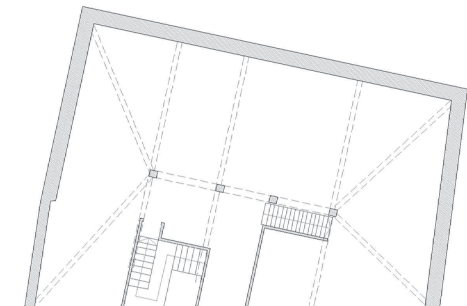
16. PLANTA BAJOCUBIERTA
